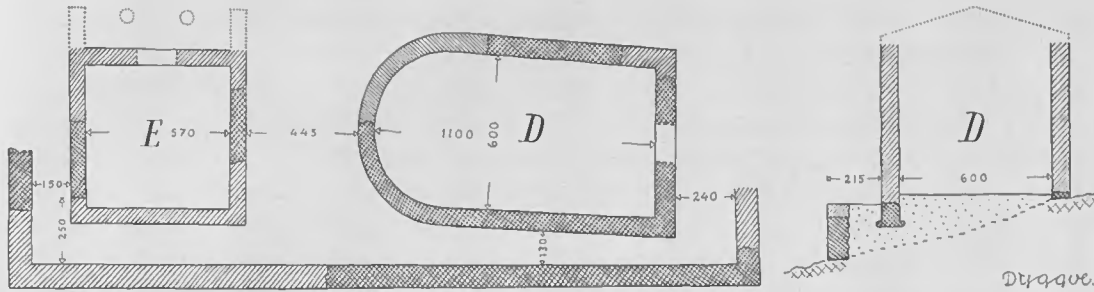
Rekonstruktion von Bau D und E mit dazugehöriger Terrassenmauer. 1:300. — E. D.
